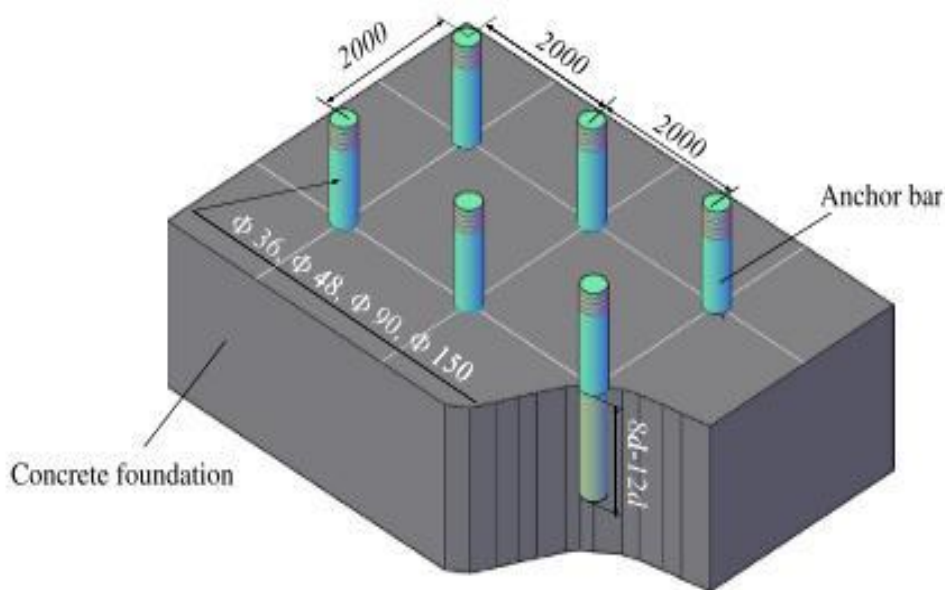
Esquema de disposición de barras en la placa de concreto (SI: mm).
